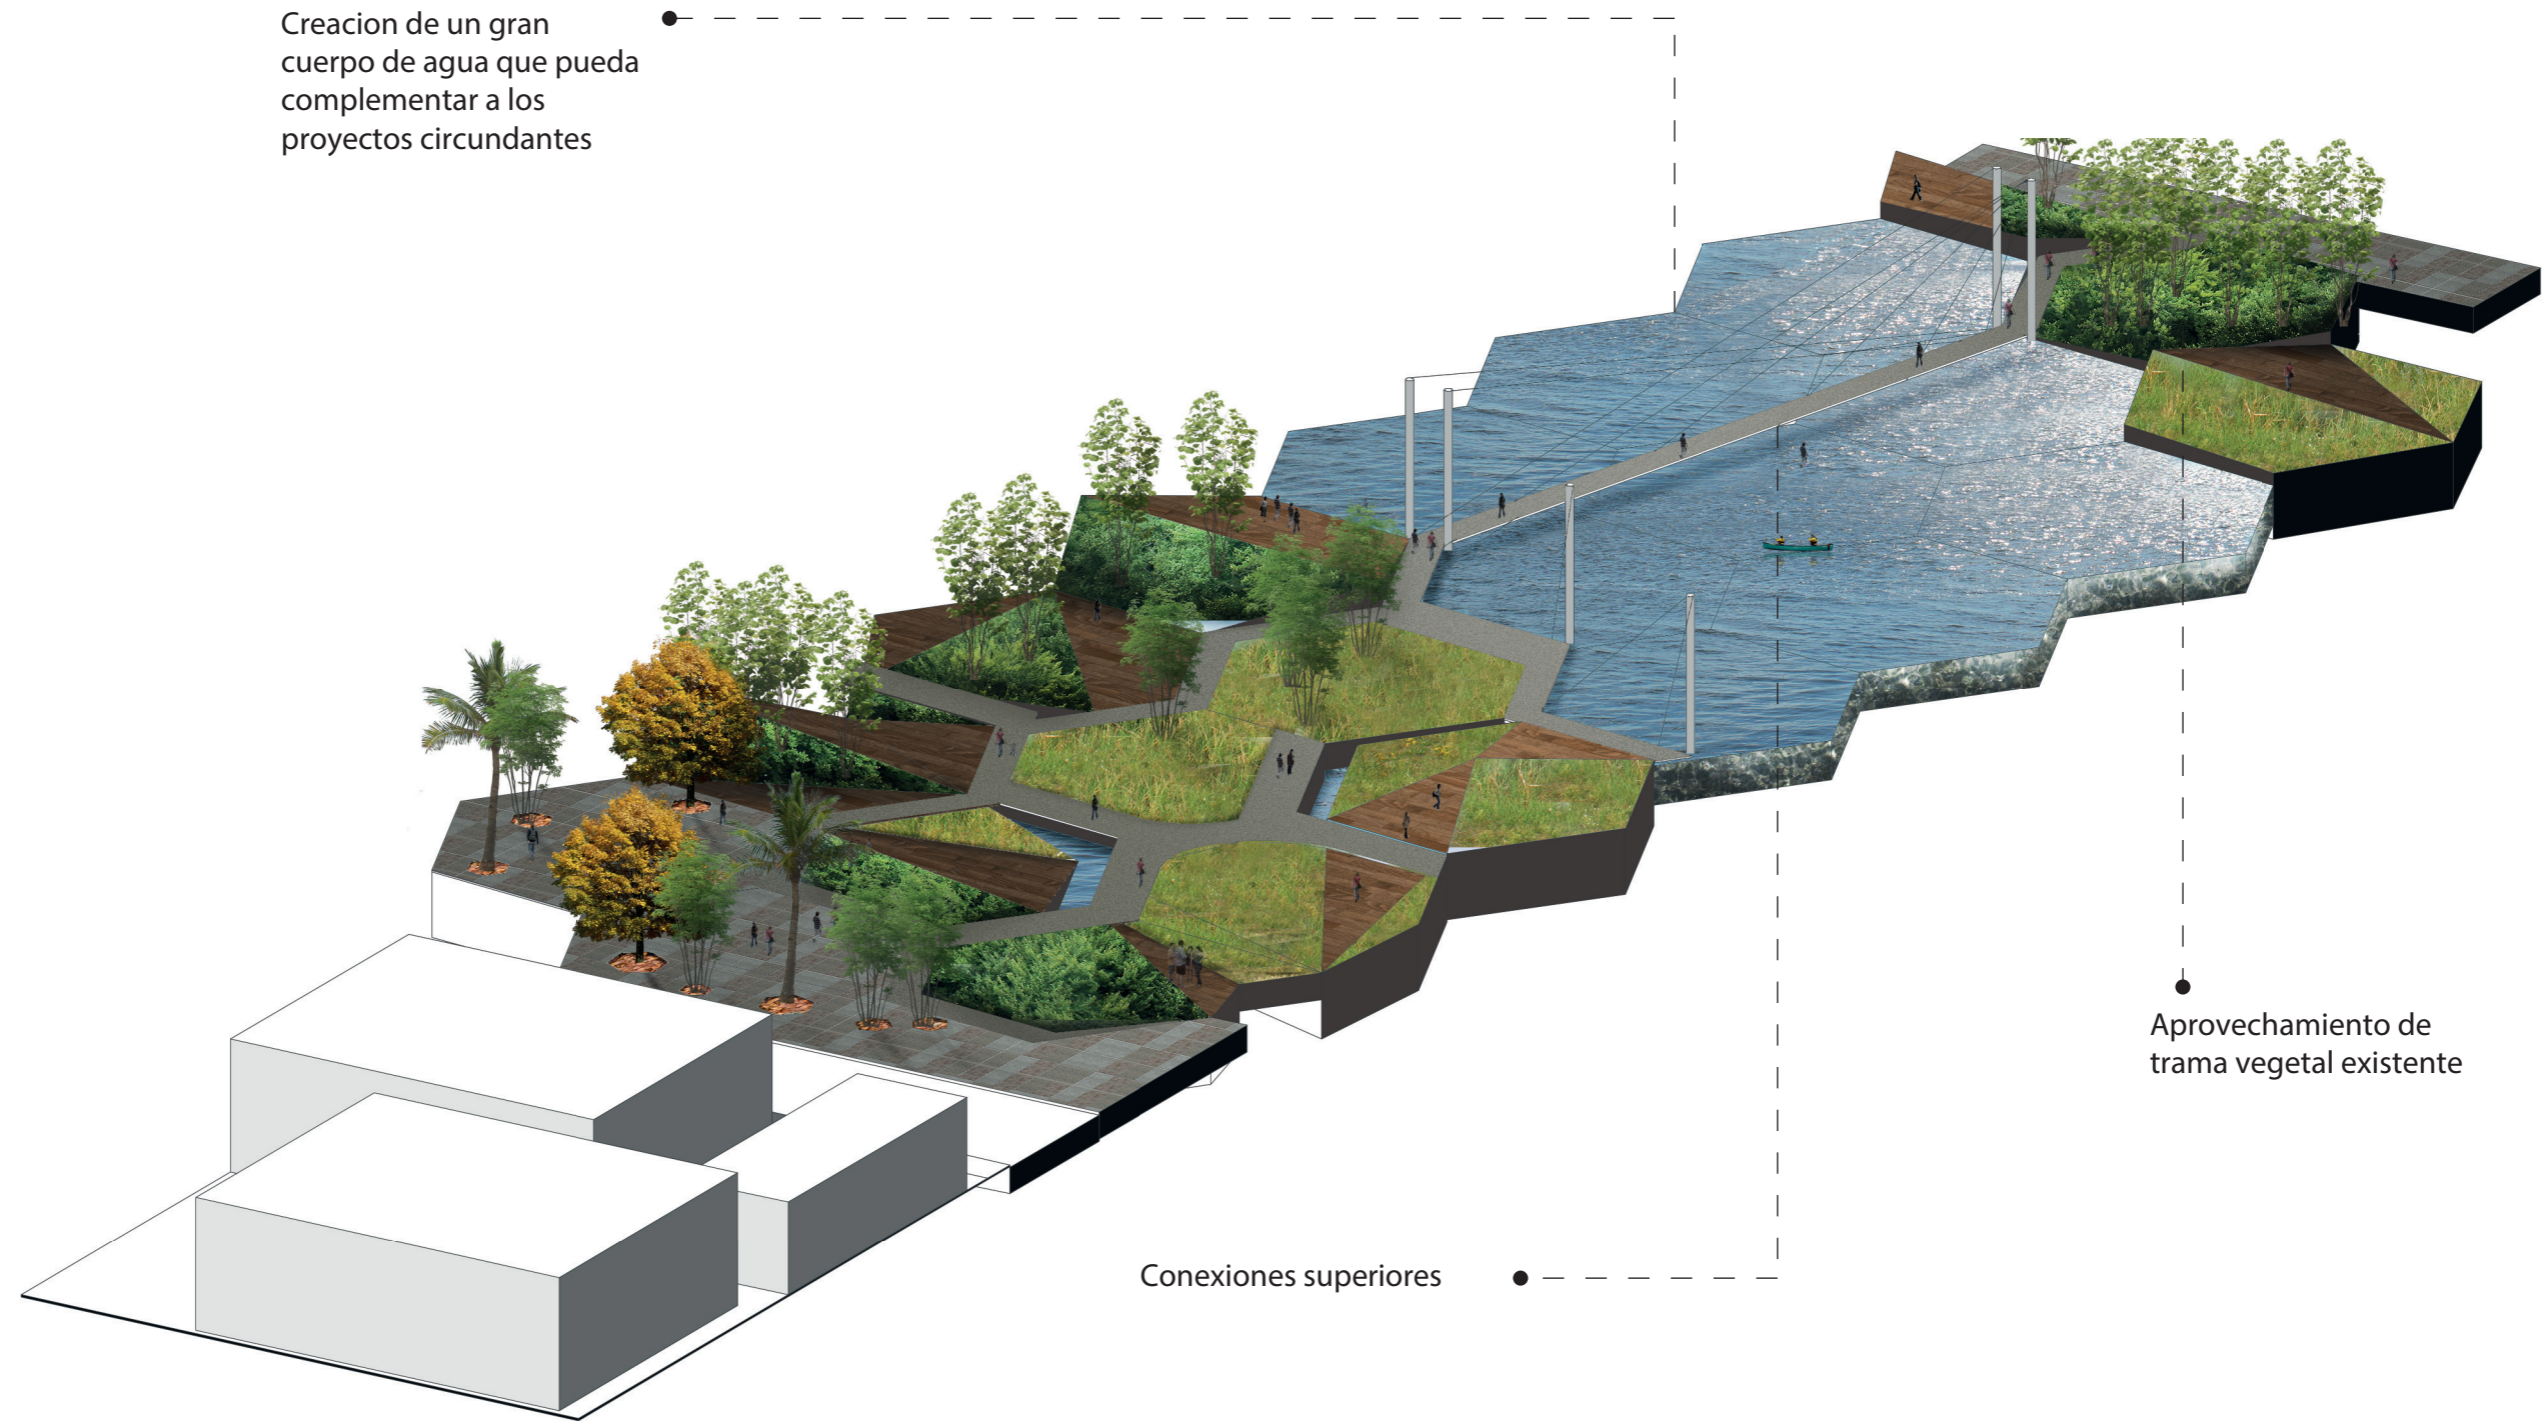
Plan Urbano de Intervención: Vista de Intervención en sección
